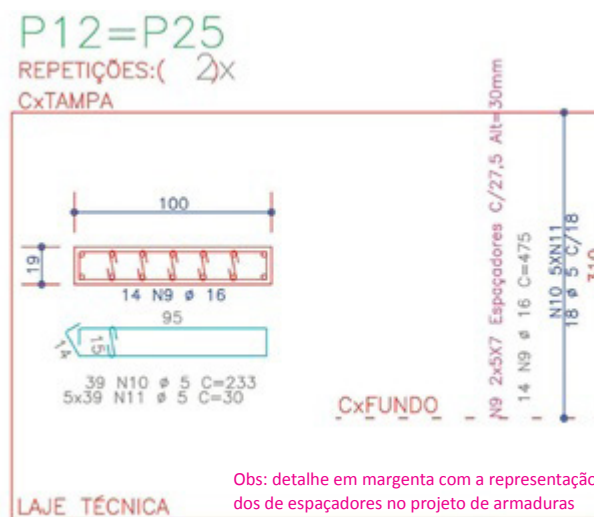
Projeto de armadura de pilares da pela barra especificada em projeto (16 mm) para a distância escolhida de 35cm = 316,40 kg;
